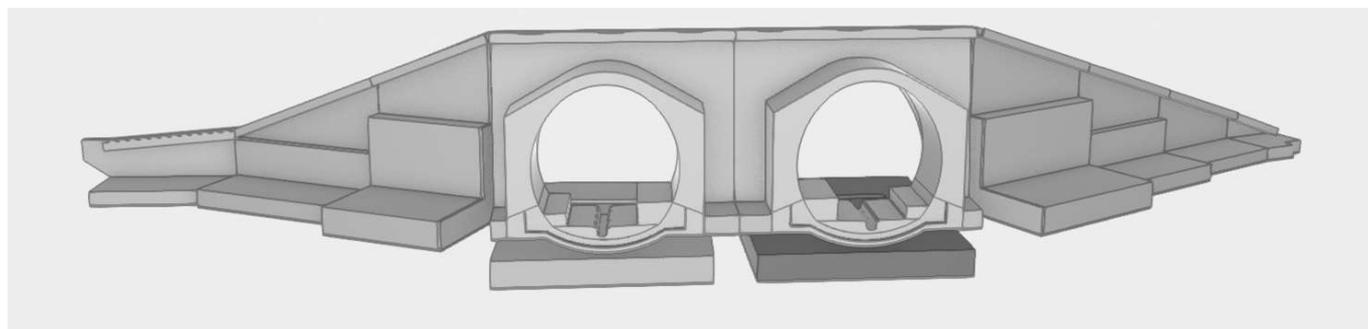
Vista prospettica dell'imbocco lato Bari
